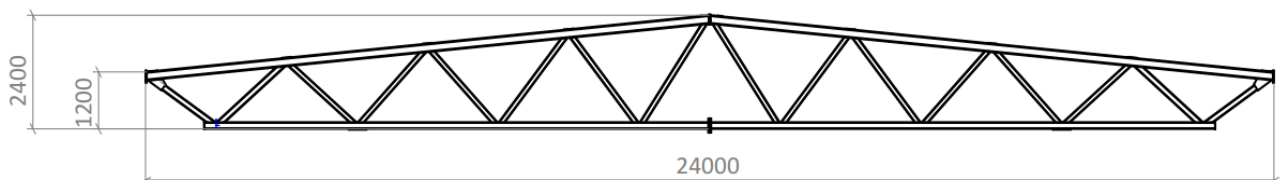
Типова металева зварна кроквяна ферма для досліджень
